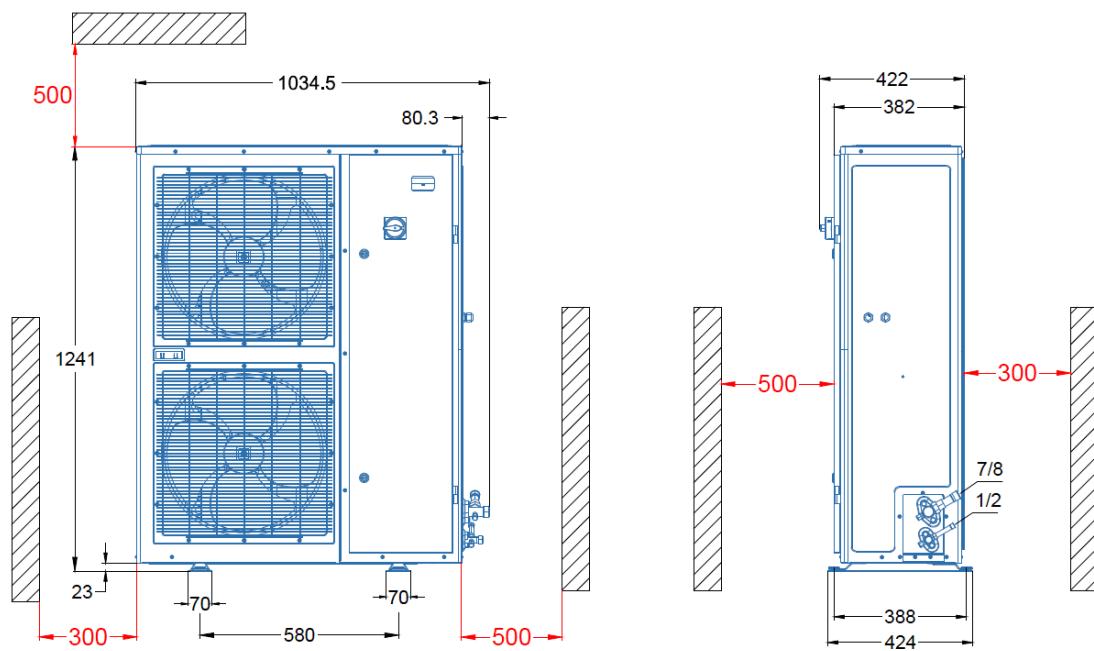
Размеры и расстояния для двухвентиляторного агрегата
